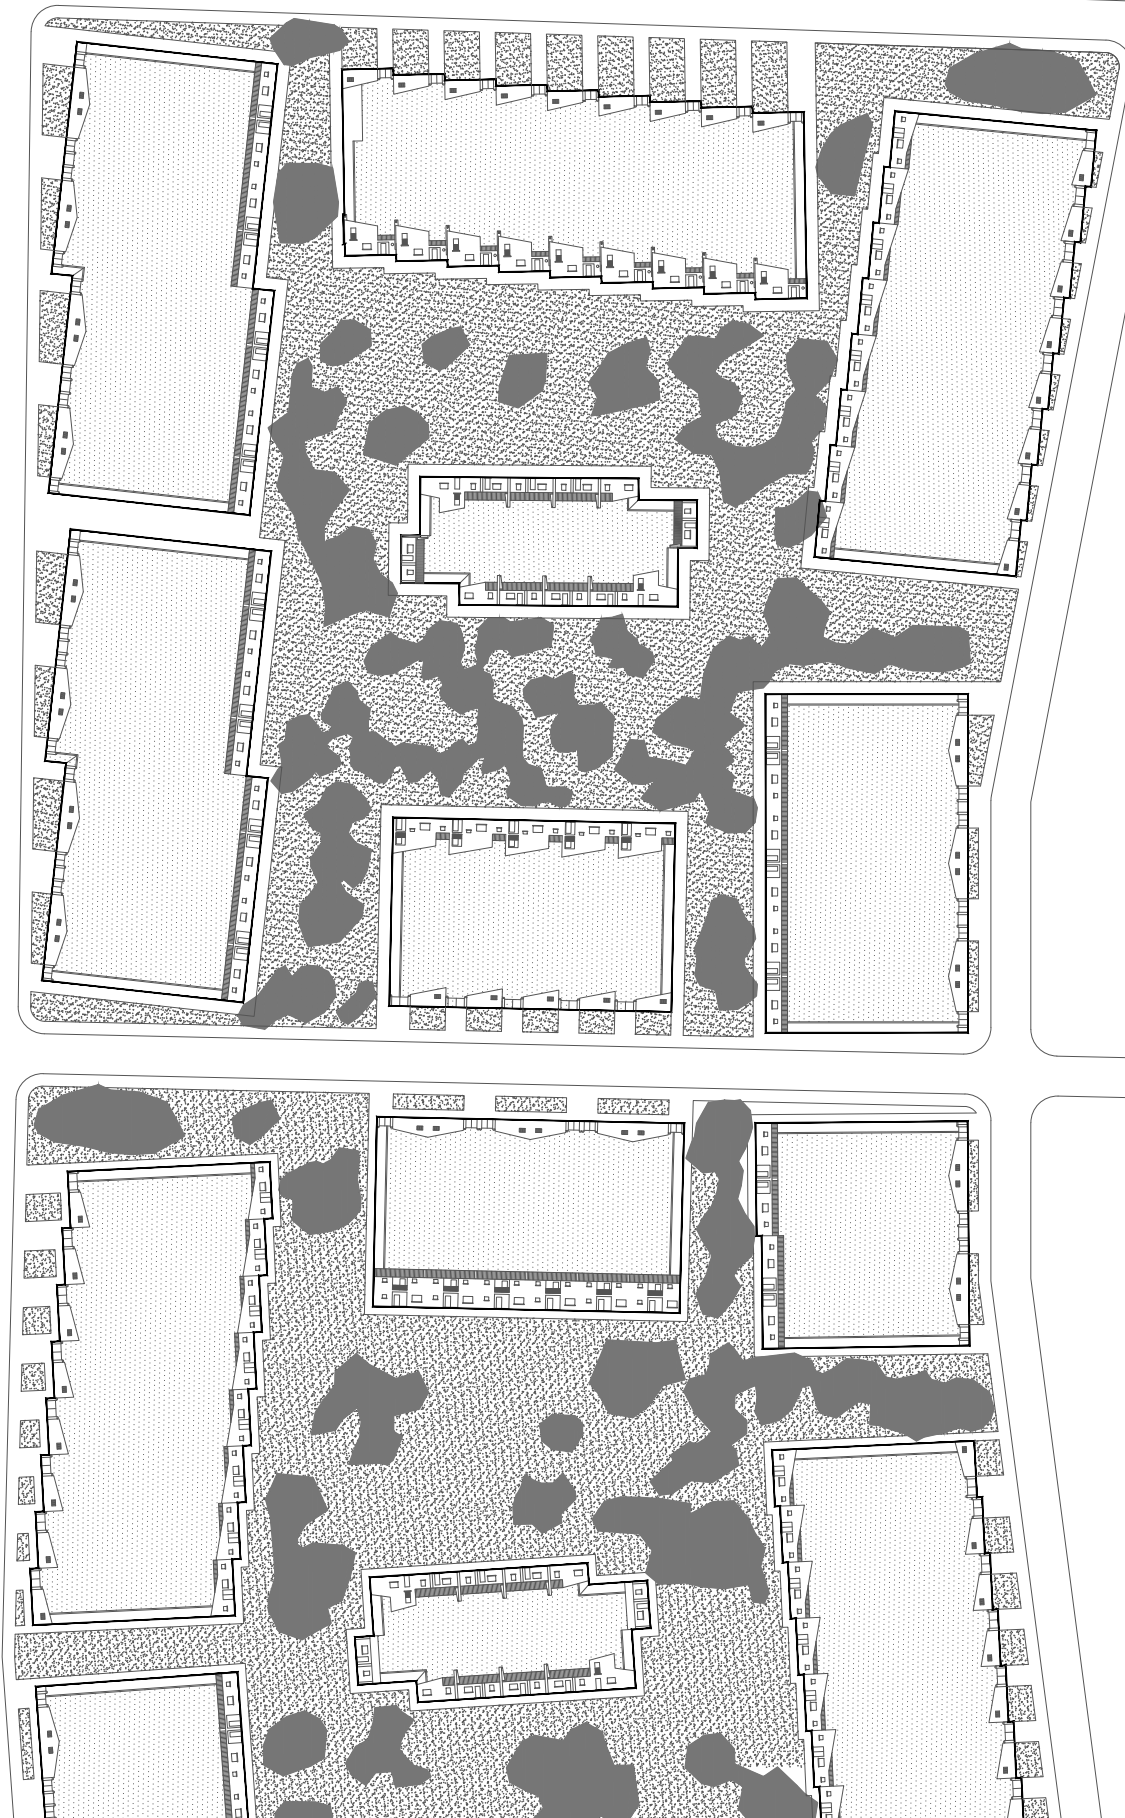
Planimetría con alzados principales abatidos para las Plazas de la Montaña y de la Isla de Vegaviana según lo ejecutado del Proyecto Unificado. Fuente: Elaboración del autor.
